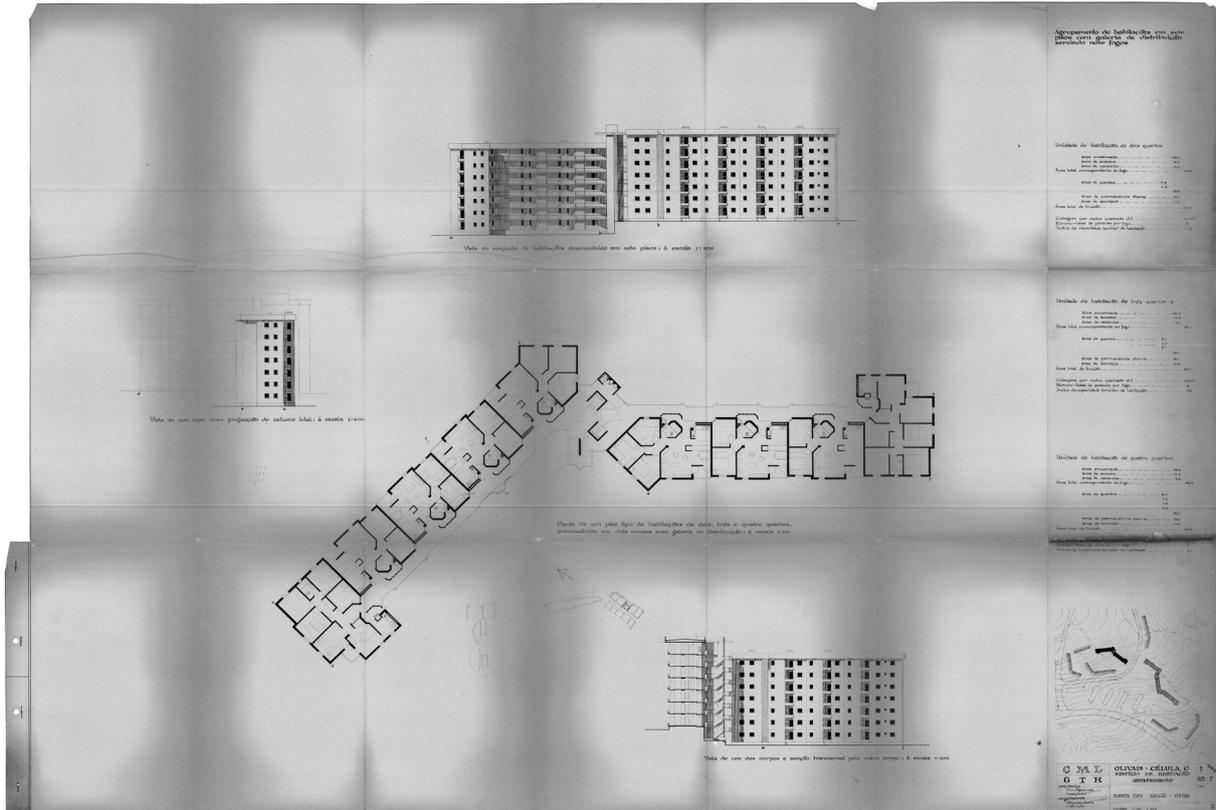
Anteprojeto: planta tipo, secção e vistas
